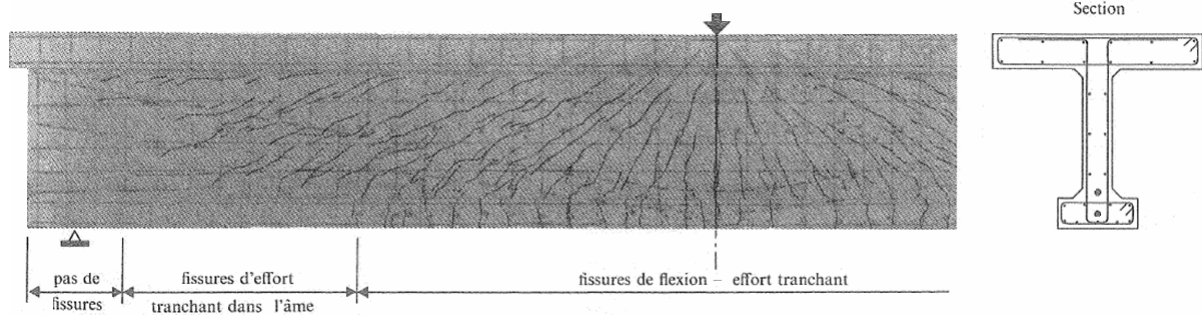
Fissuration d'une poutre sur appuis simples : flexion trois points (Leonhardt, 1971)
